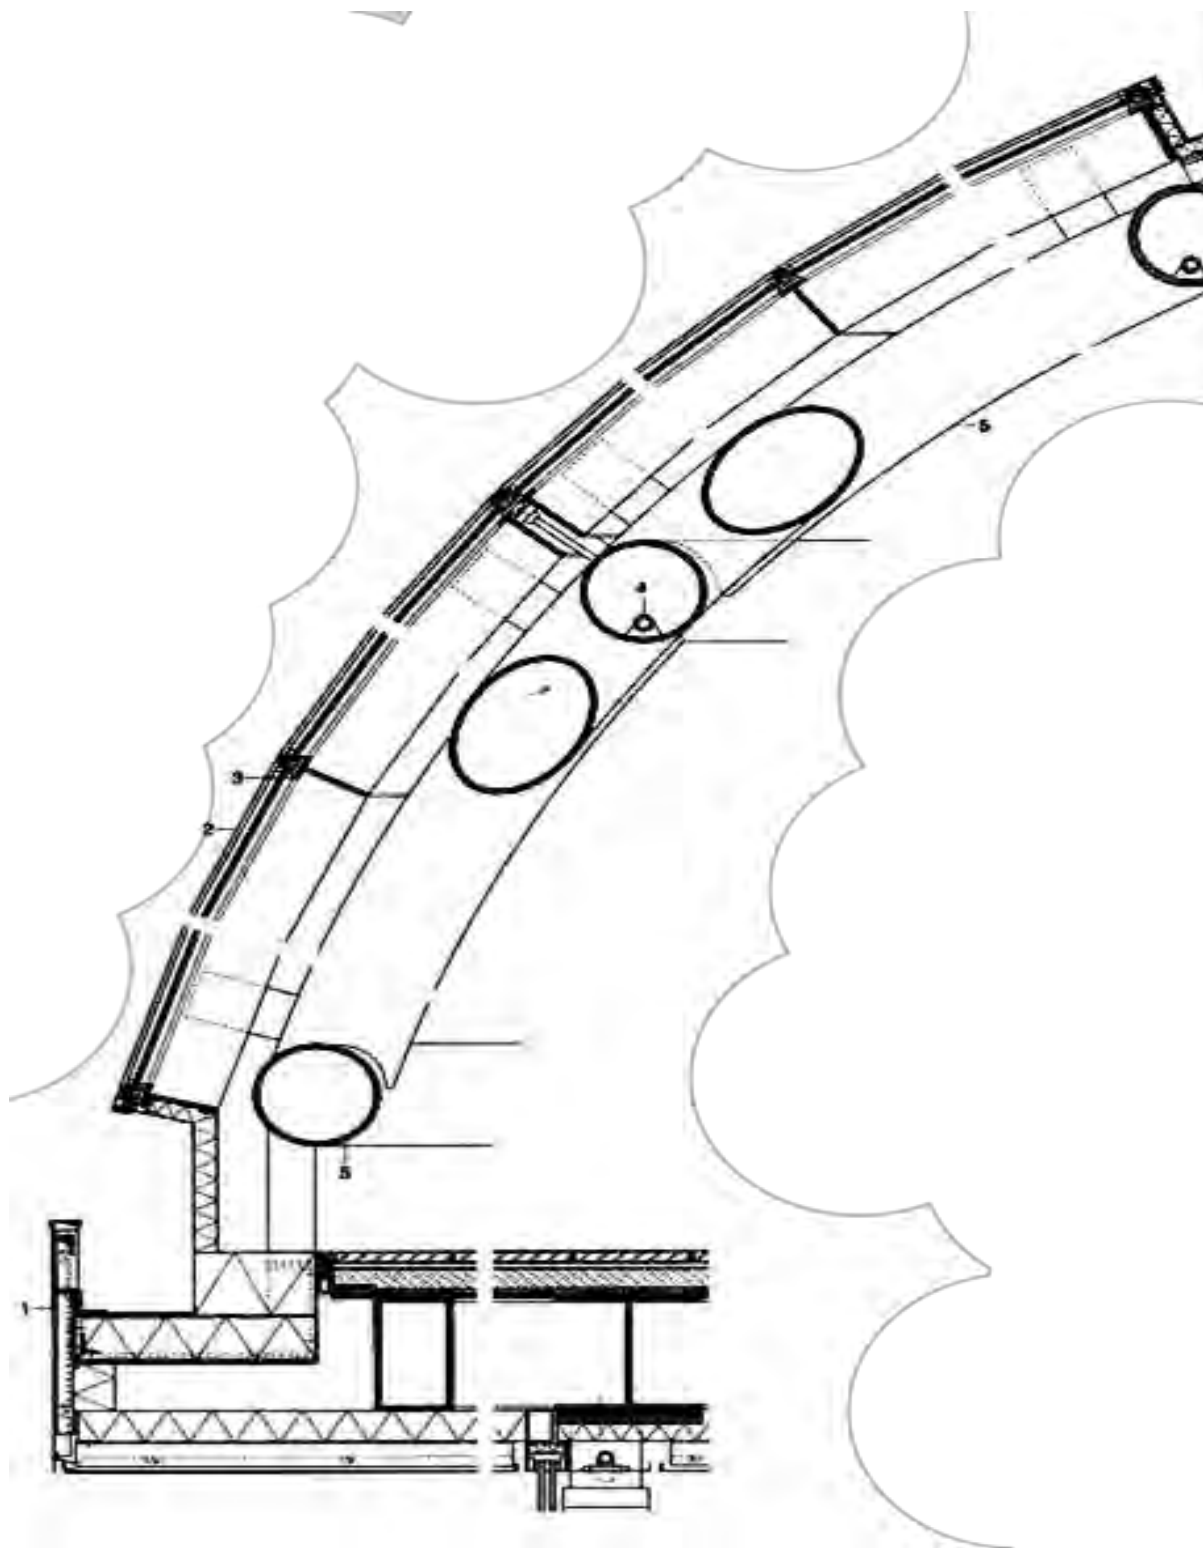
Деталь (1-я половина): 1– двухмиллиметровое защитное алюминиевое покрытие; 2– двойное остекление: 10 мм прессованного стекла + 18 мм полость + ламинированное защитное стекло, изолированное по канту; 3– 180/75/12 сварная стальная *t*-образная секция; 4– нагрев потока воздуха; 5– стальной цилиндр; 6– 2 мм однослойная мембрана, 80 мм теплоизоляция, пароизоляция, 40/183/0,88 трапецевидная листовая сталь, 120/80/10 стальные уголки
